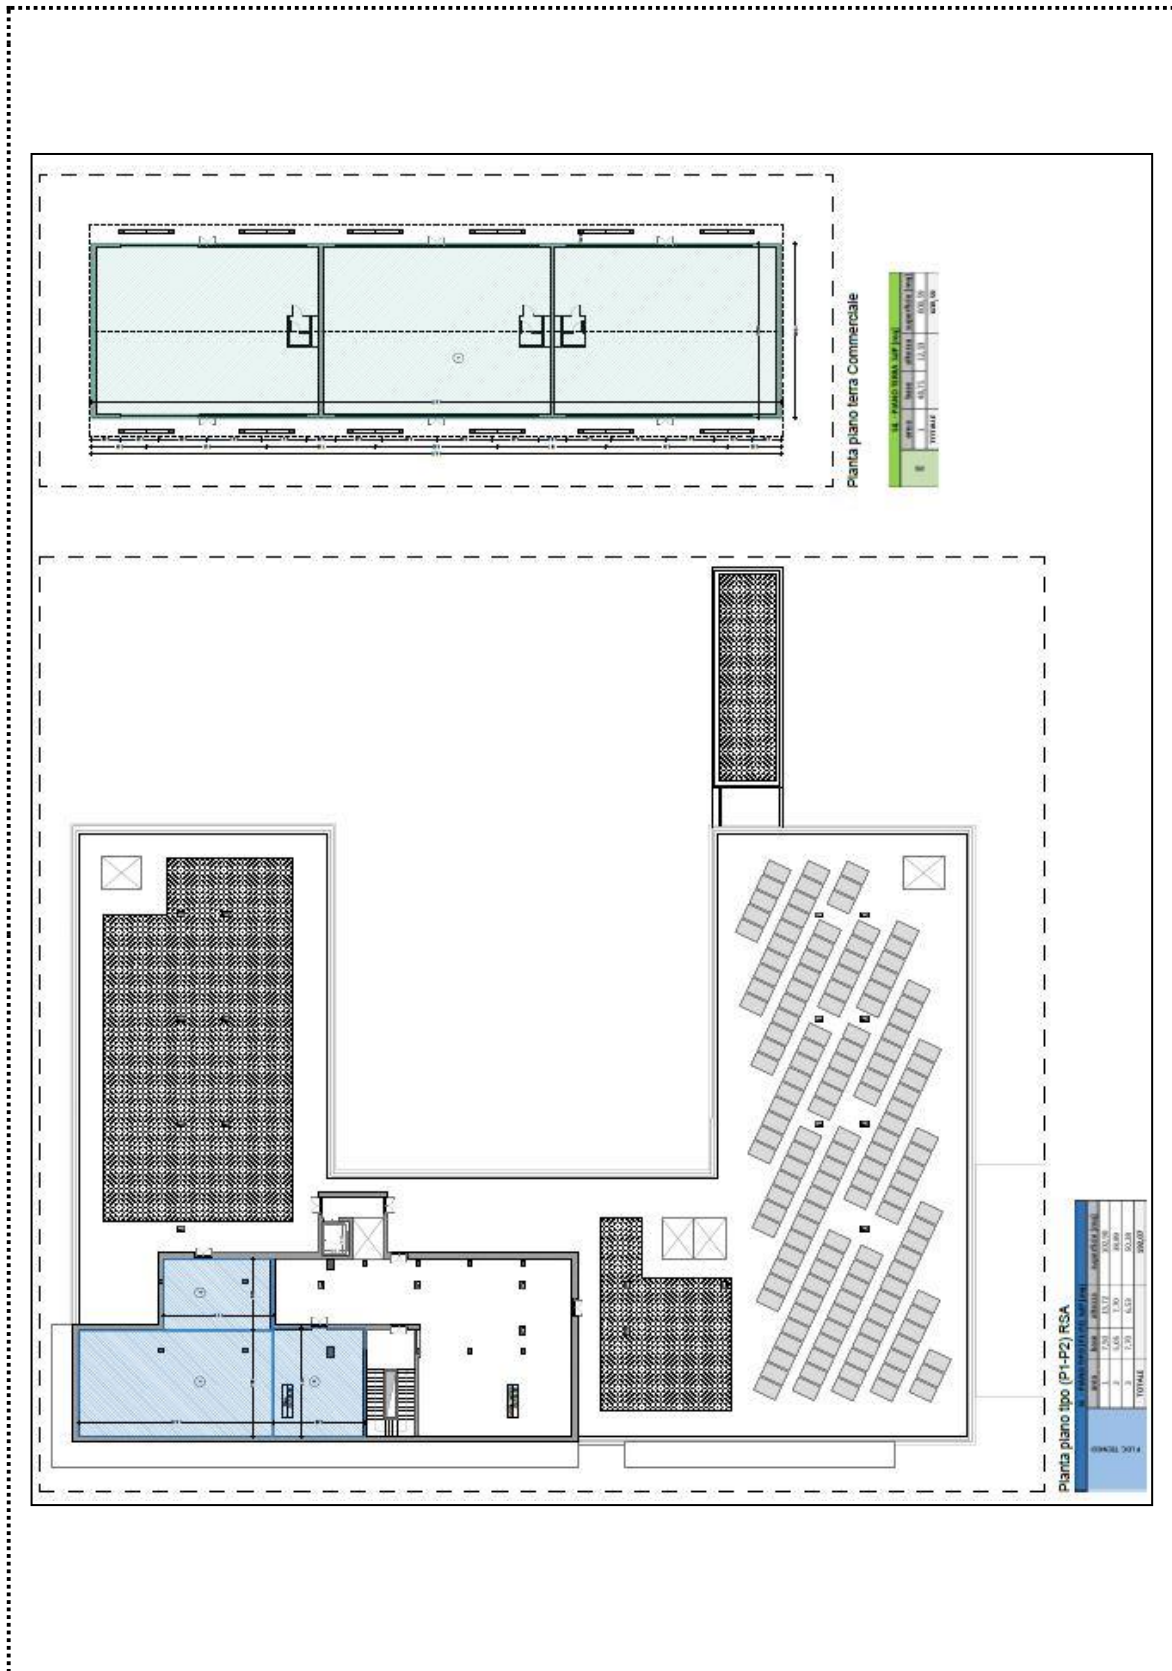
Verifica superficie lorda – pianta piano locale tecnico (T.16)
